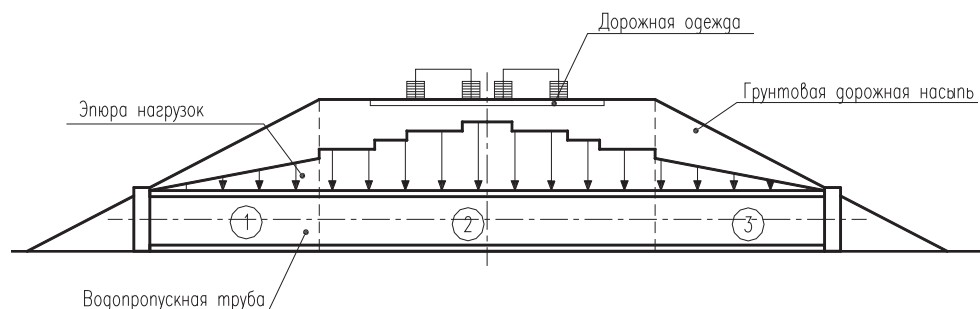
Общая схема загрузки водопропускной трубы грунтовой нагрузкой и нагрузкой от подвижного состава по всем полосам движения
